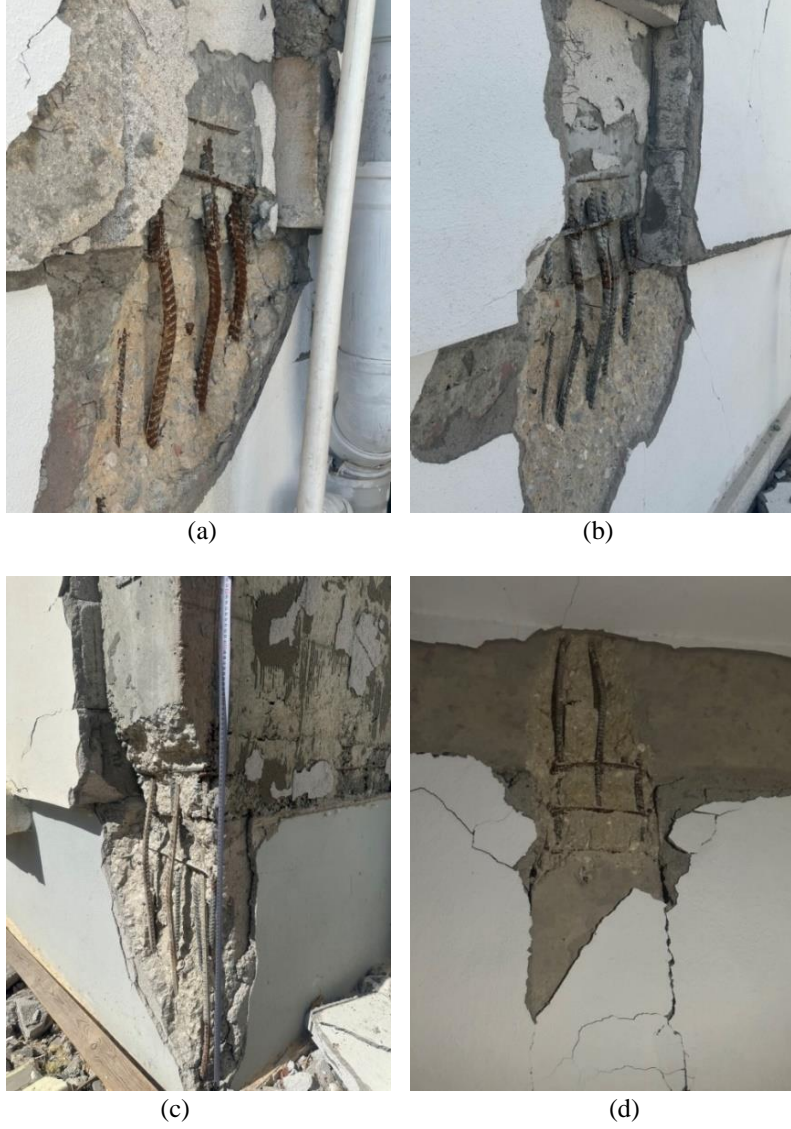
Betonarme çerçevelerde etriye kullanım bölgeleri
